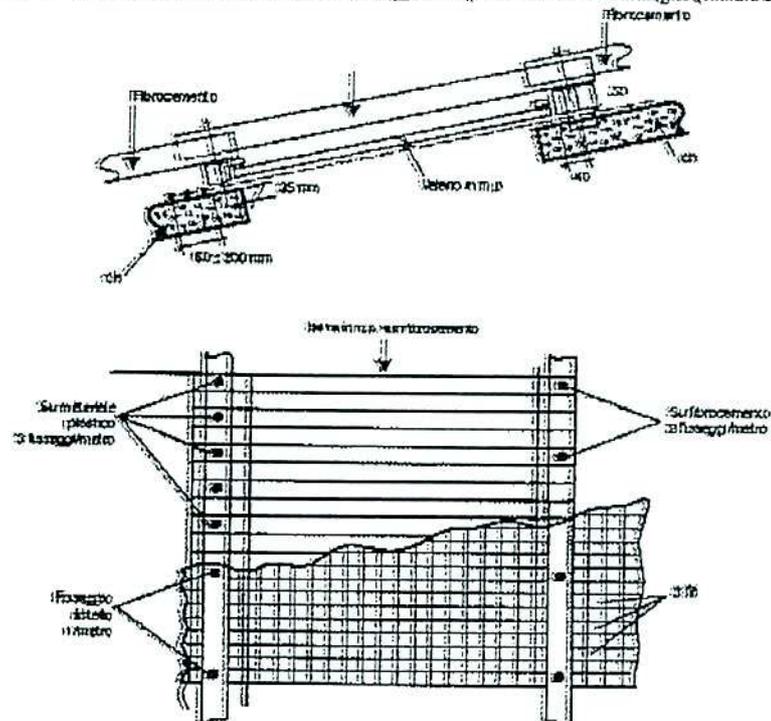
Esempio di copertura in fibrocemento con lucernario: sezione vista est/ovosso di rete fissata sotto listelli
